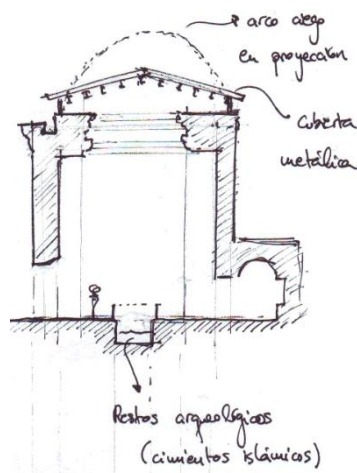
Croquis de la sección del proyecto de 1979 de Pedro San Martín.
